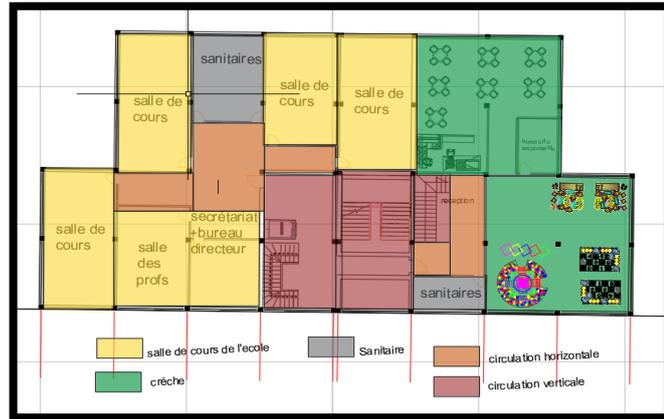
plan 3eme et 4eme étage (source : auteur).
